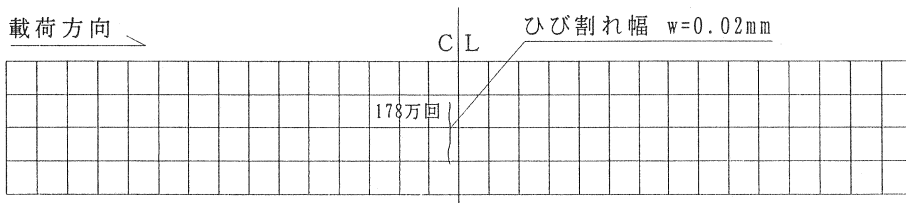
コンクリート床版上縁ひび割れ観察図
